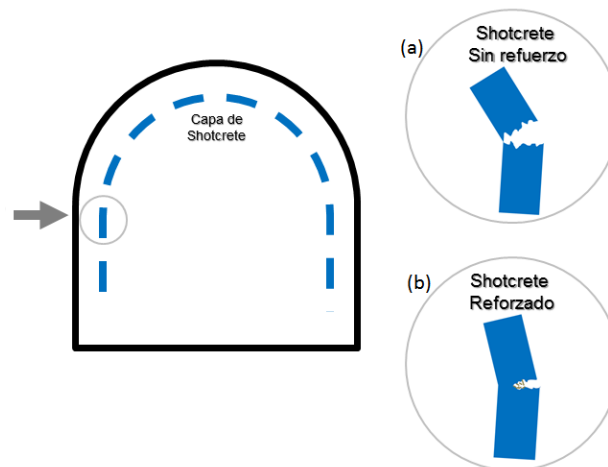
Esquema de falla para shotcrete con y sin refuerzo
